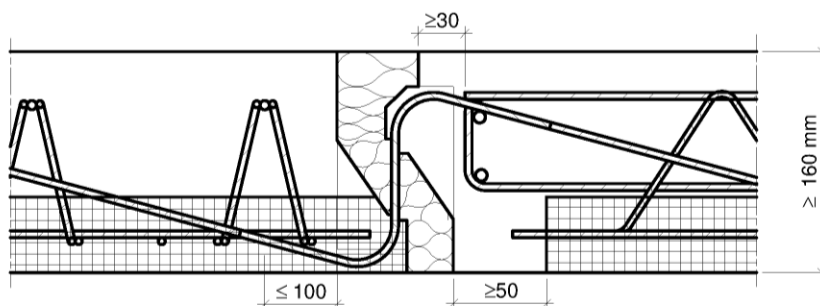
Beispiel Schöck Isokorb® Typ V mit Elementplatten
